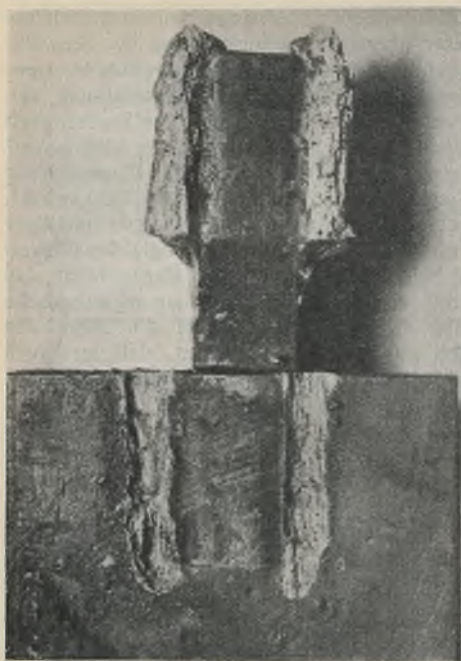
Scherfläche im Schweißseisen bei einer Probe der Gruppe 1.
